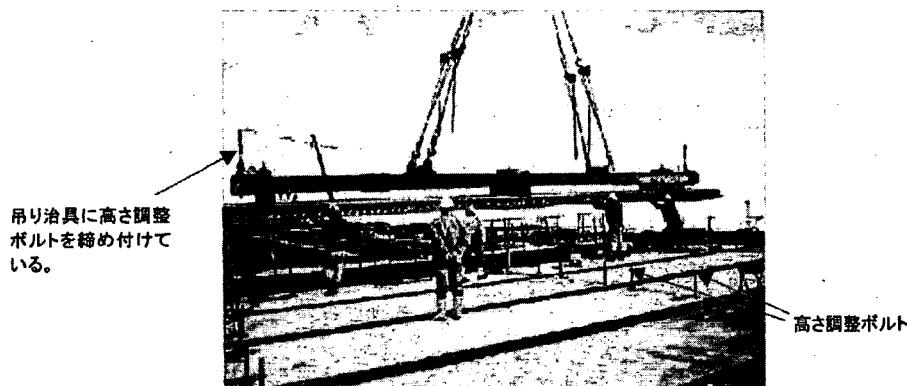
高さ調整用金具と吊金具兼用の施工例
